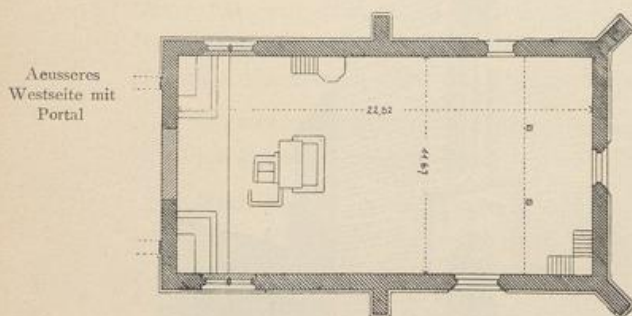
Wimpfen im Thal. Grundriss der Kornelienkirche.
